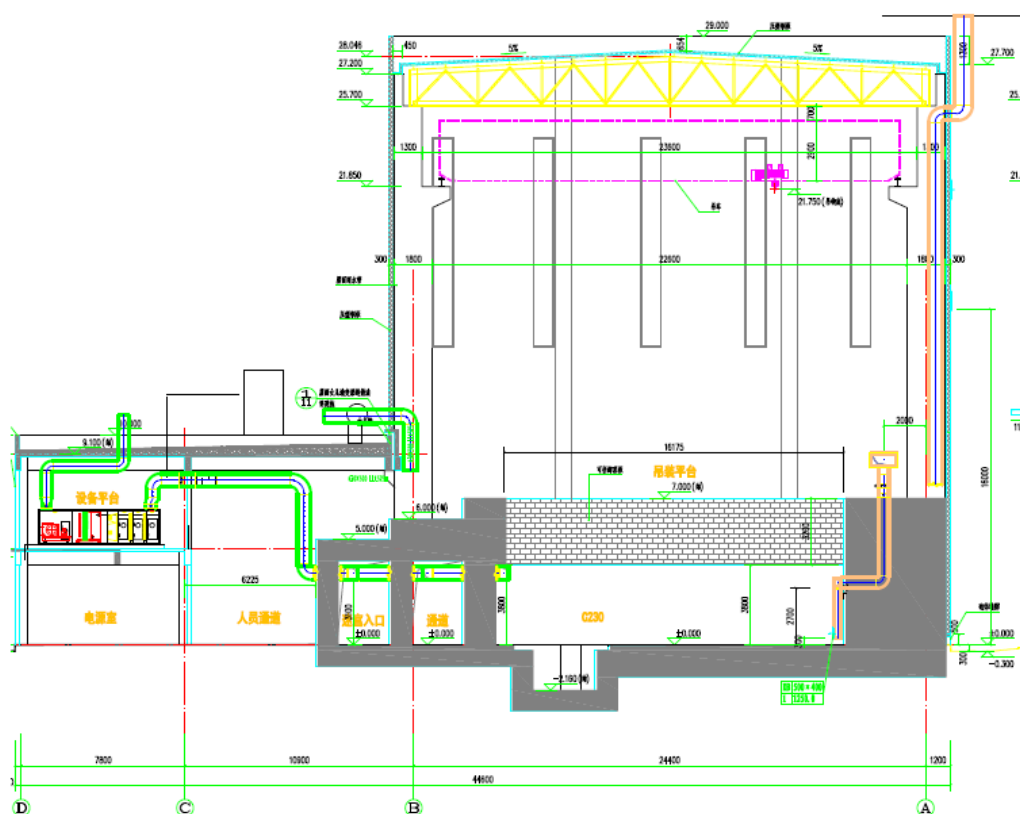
通风管线穿越屏蔽墙体示意图（垂直布置图）
